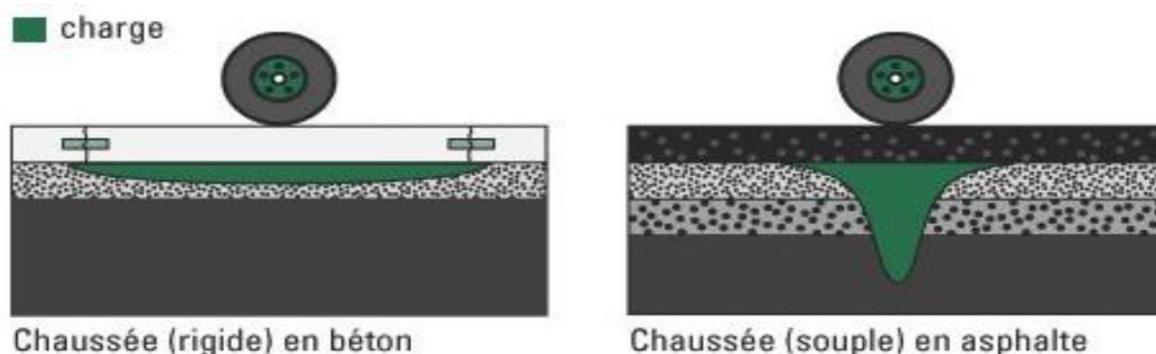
Répartition de la charge sur la chaussée en béton et la chaussée en asphalte.
